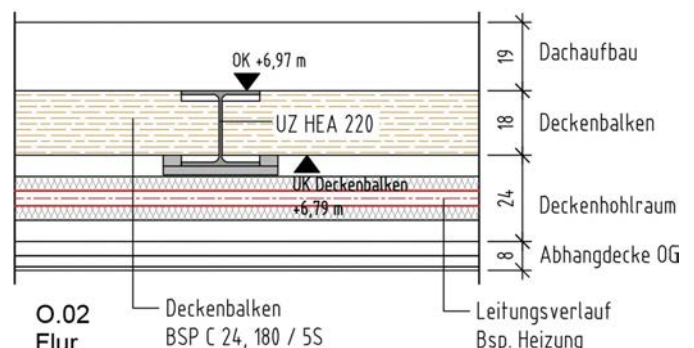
Detailschnitt Decke/Dach OG (Quelle: inPlan Ingenieurbüro TGA GmbH)
